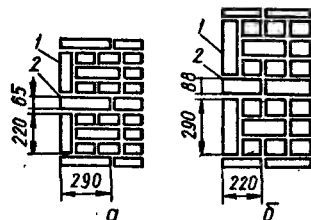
Кладка из кирпича, облицованная плоскими плитами с прокладными рядами из тех же плит:
